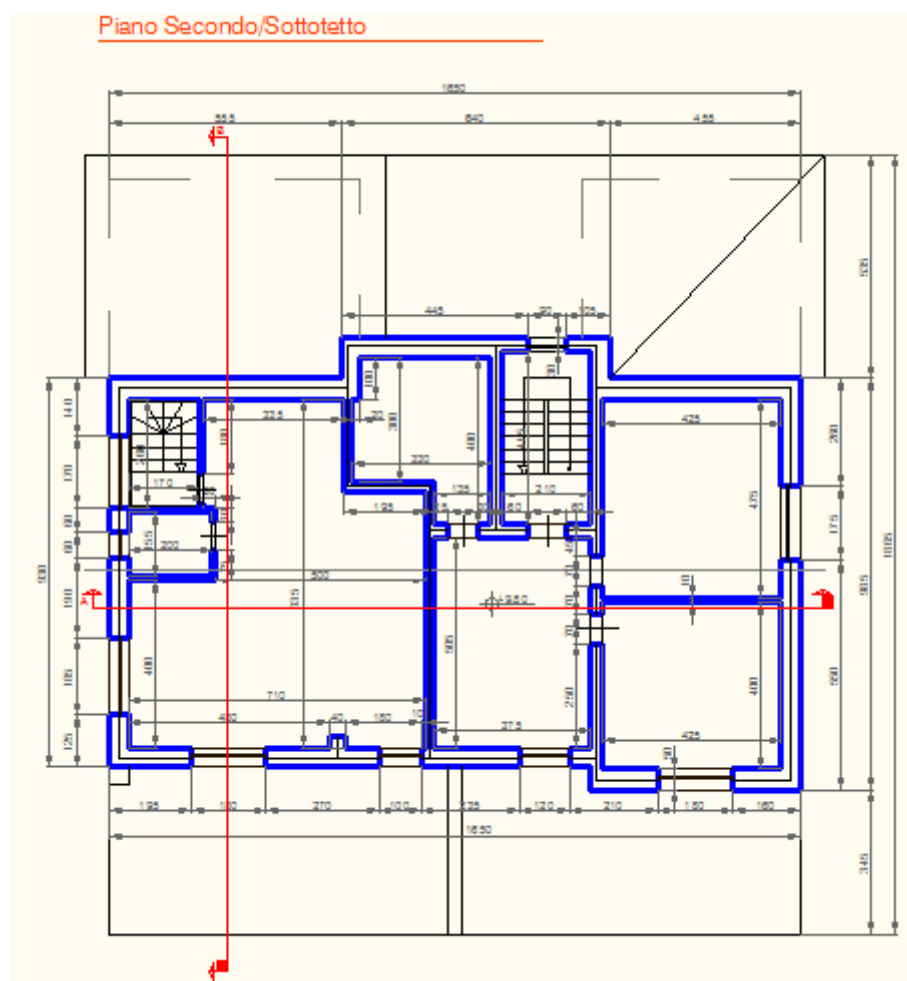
Planimetrie dell'edificio oggetto di studio.
